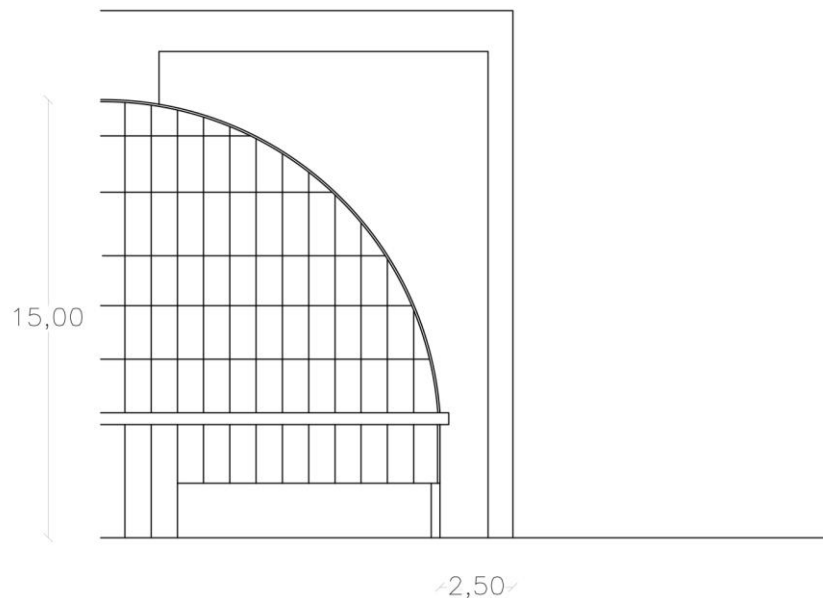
Pórtico en la fachada principal el 29 Julio a las 20:00 horas (Elaboración propia)
